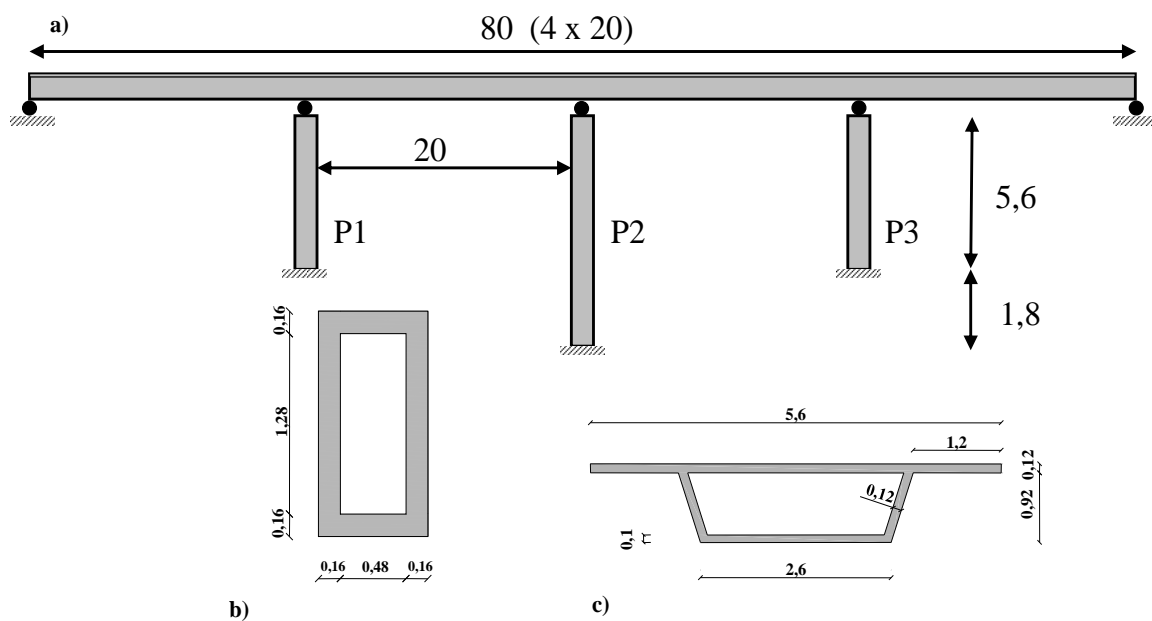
Viaduc : vue en plan du viaduc. a) Vue en plan de la maquette en béton armé à l'échelle 1:2.5 (Pinto, Verzeletti et al. 1996), b) Schéma des piles, c) Schéma du tablier (dimensions en mètres).
